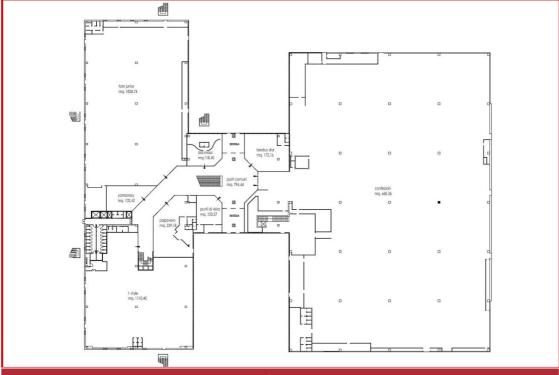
Pianta piano terra dell'esercizio commerciale – non in scala
